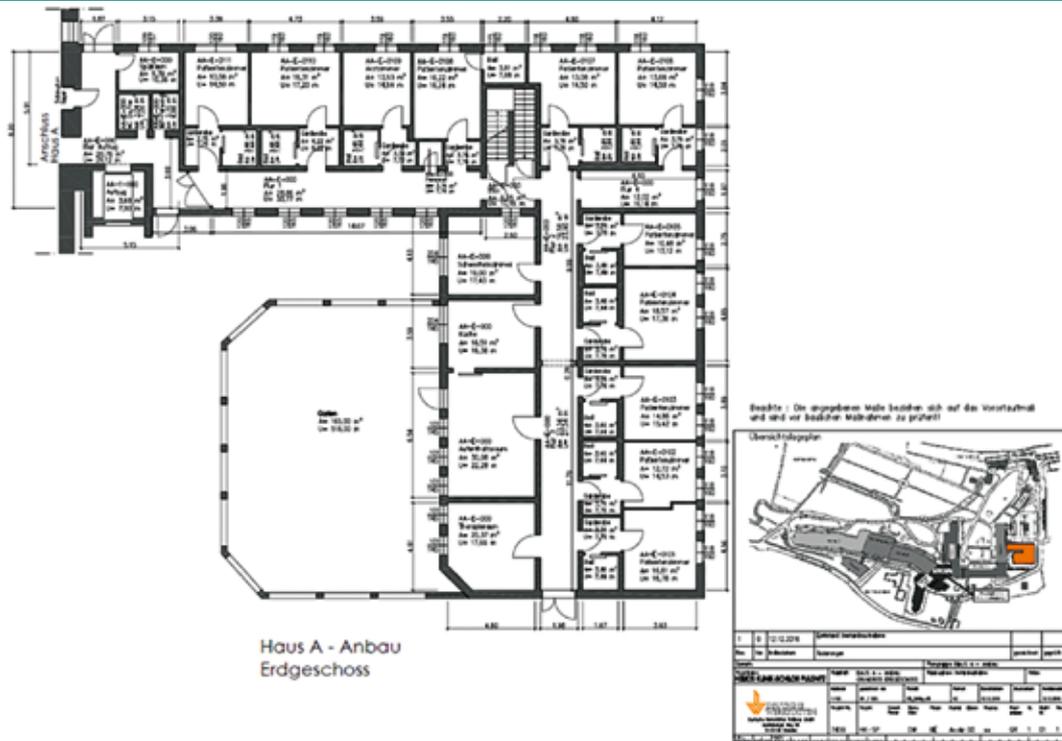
Grundriss geschützte Station mit Hof-/Gartenanteil
